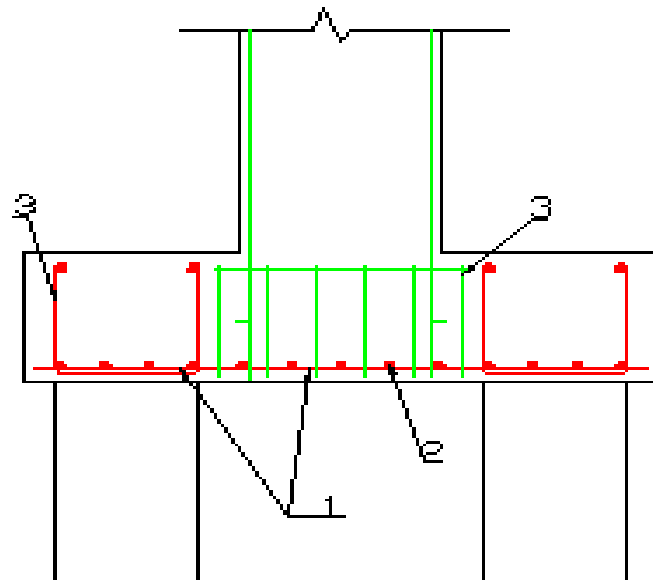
Схема армування фундаменту: 1 – арматурно-контурні пояси для сприйняття розпору; 2 – арматура центральної зони ростверку; 3 – хомути контурних поясів.
